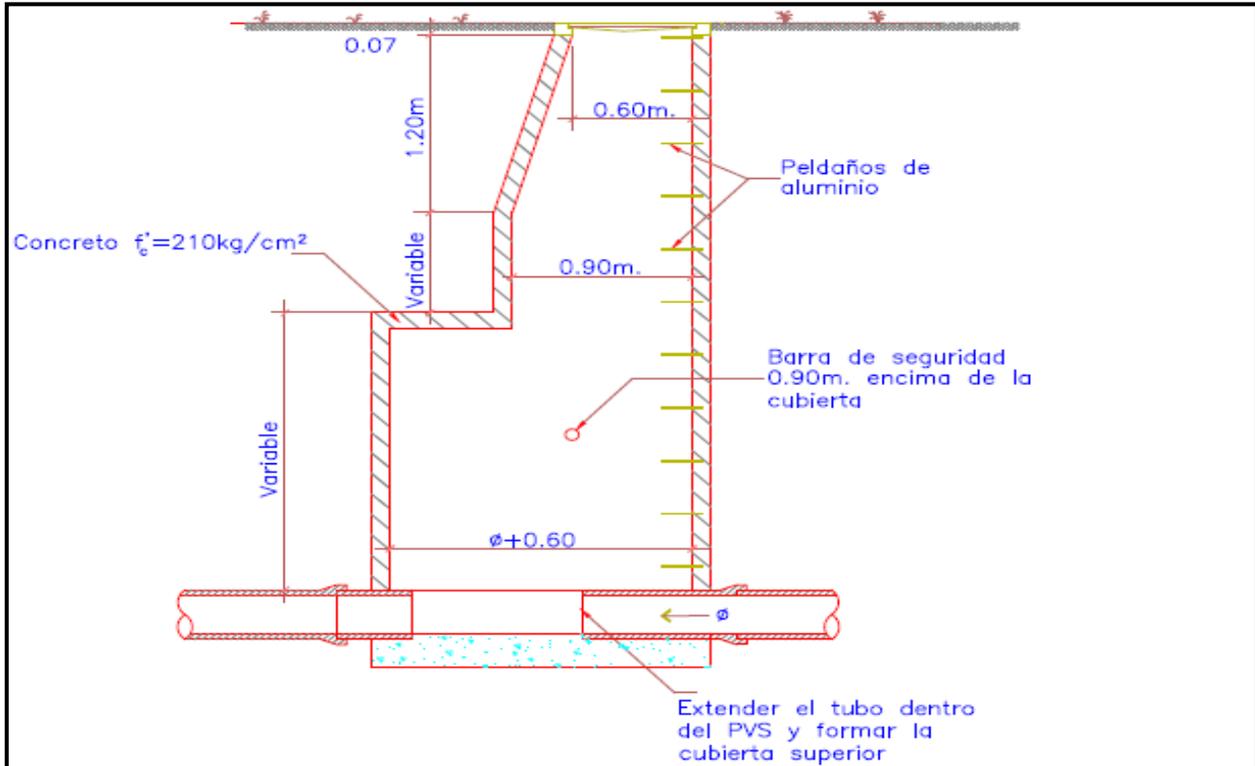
Pozo de visita típico para alcantarillas con diámetros mayores a 750 mm.
